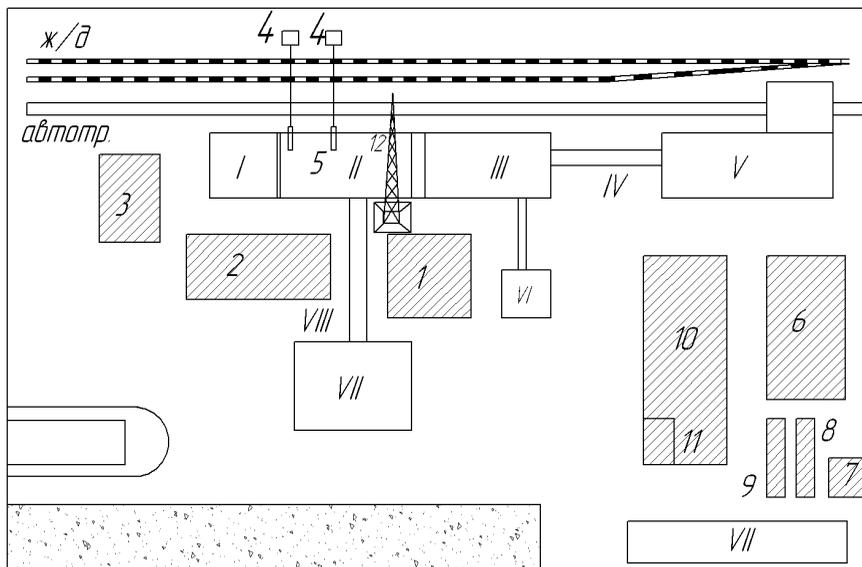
Стройгенплан периода монтажных работ комбикормового завода
